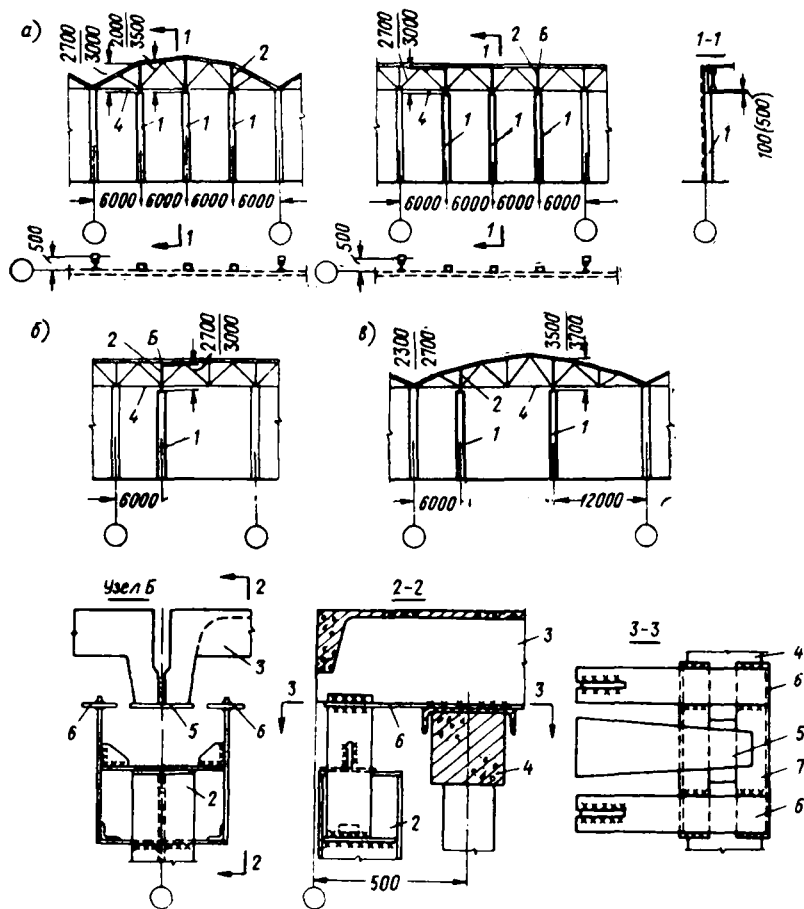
Схема фахверковых стоек в торцах зданий
